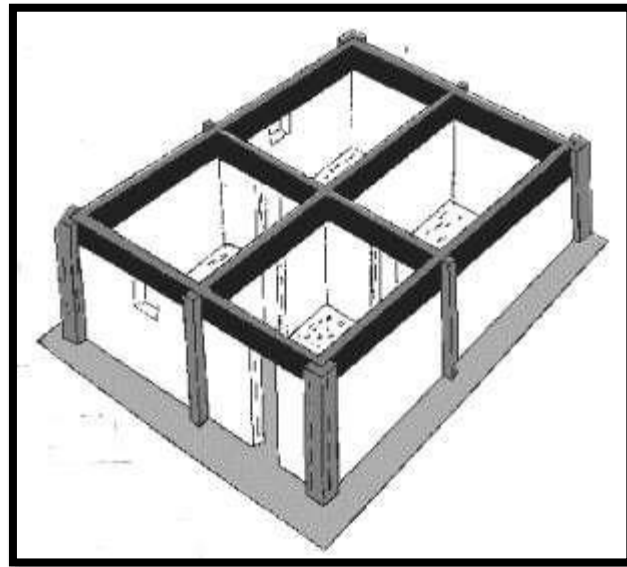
Tipos de amarre en muros de adobe (MVCS, 2010)
